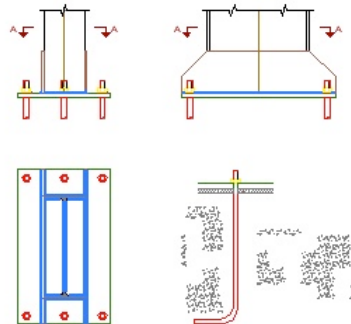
Placa de anclaje de los pilares del pórtico de fachada.
